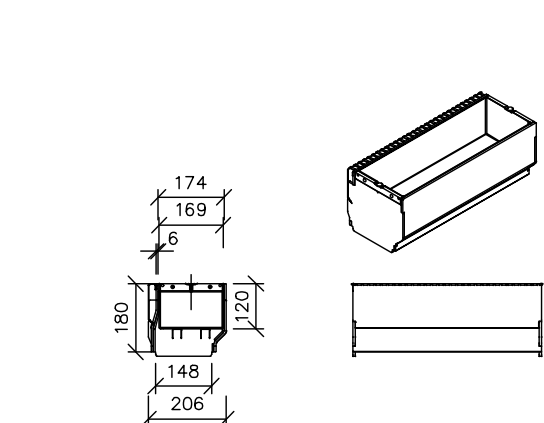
DETAIL BOČNÍ ŠTĚRBINY TSH 1500/160
